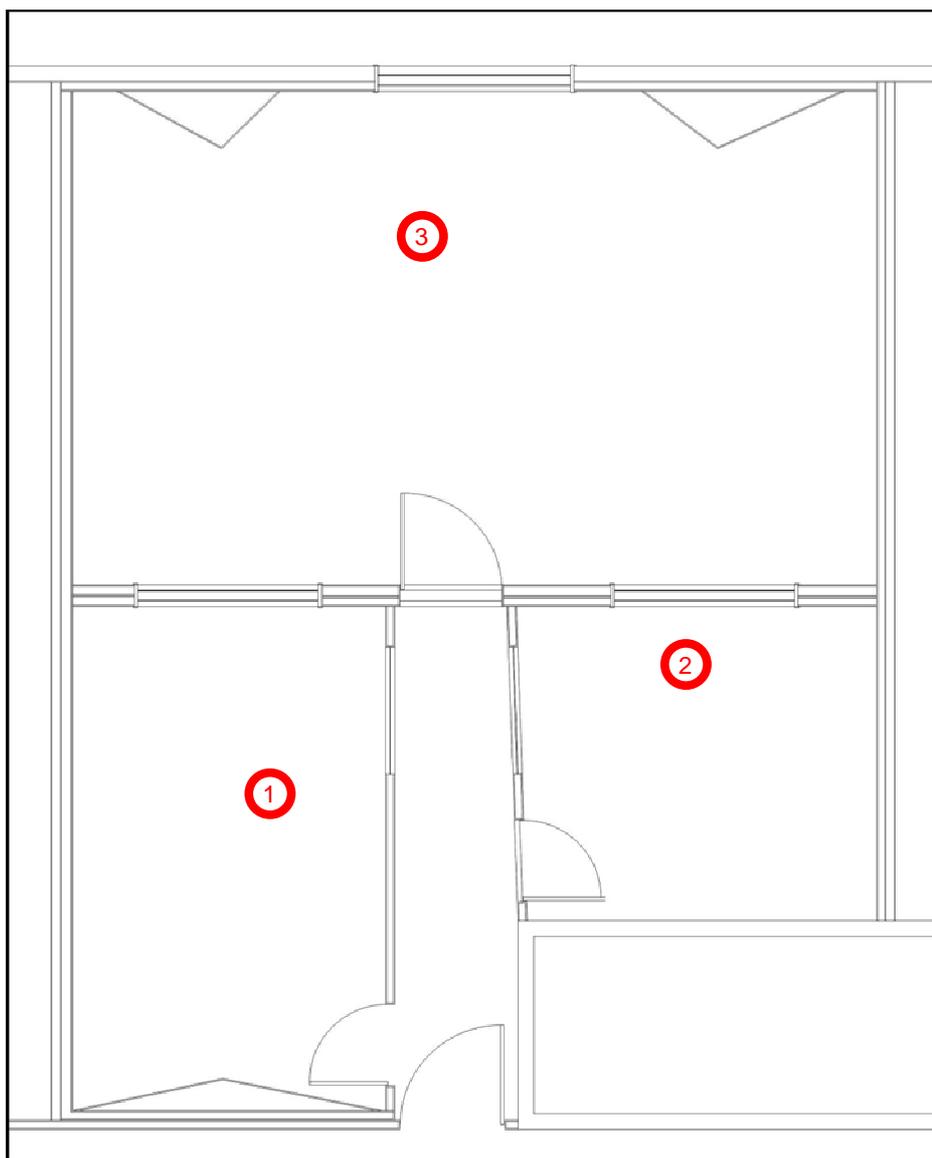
Planta baixa do estúdio da faculdade AESO.
